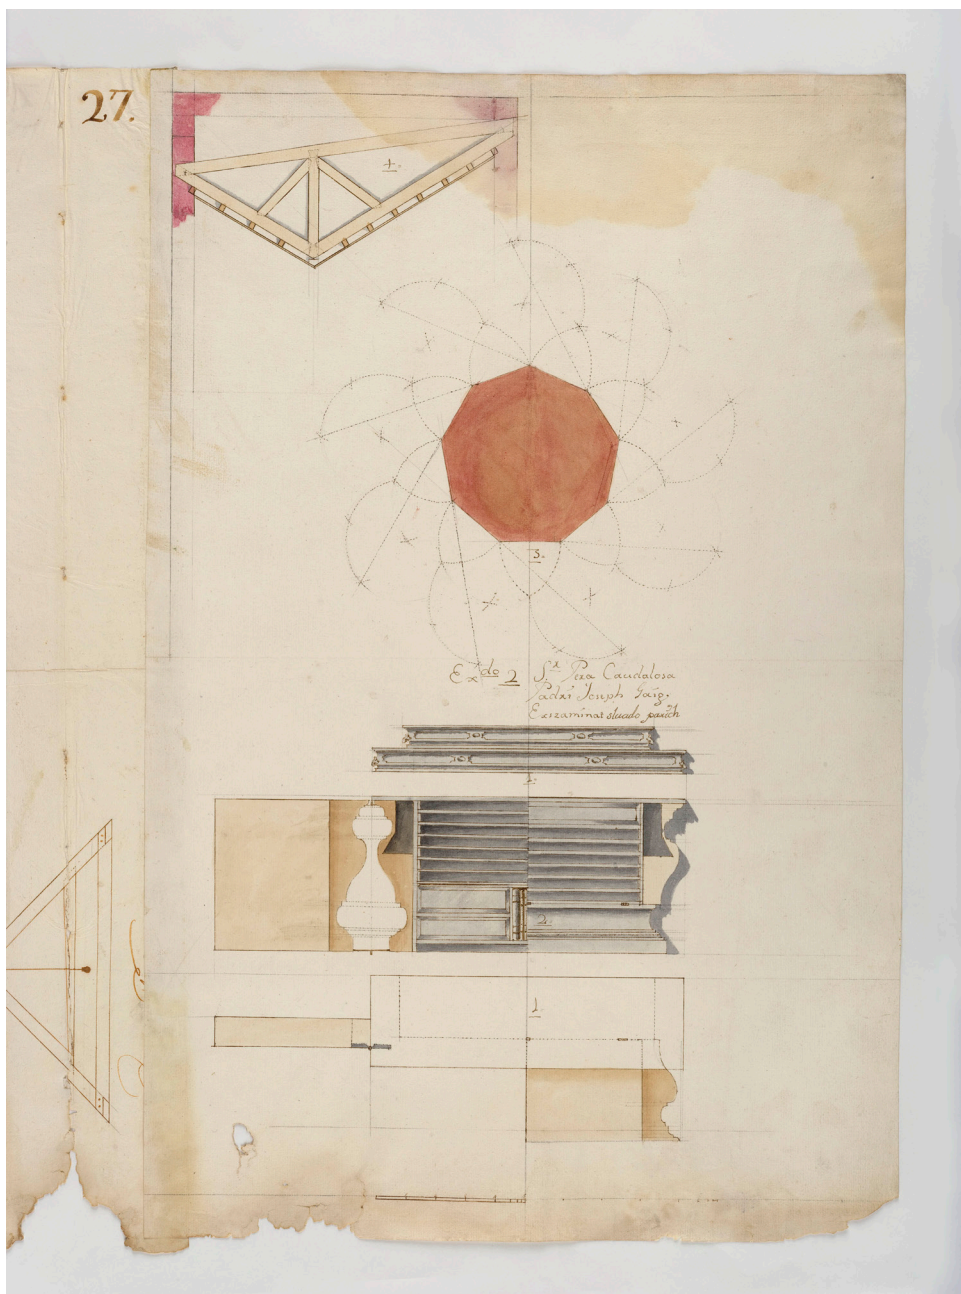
P. 27. Salvador Perich Duran. Cómoda altar, planta y alzado. Cercha.
